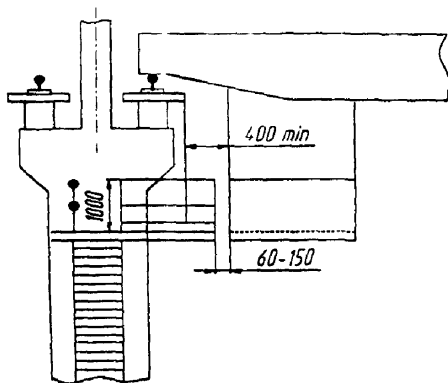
Схема размещения посадочной площадки (1 вариант).
